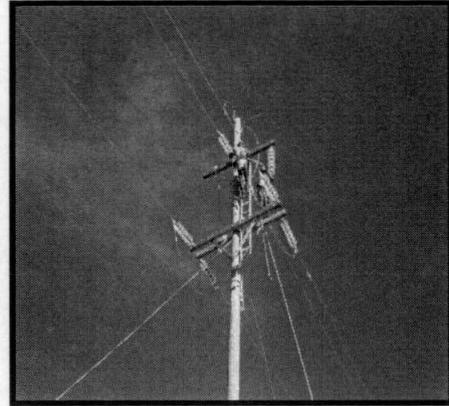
Estructura de madera, 02 trabajadores asegurando los elementos de aislamiento de los conductores eléctricos.
